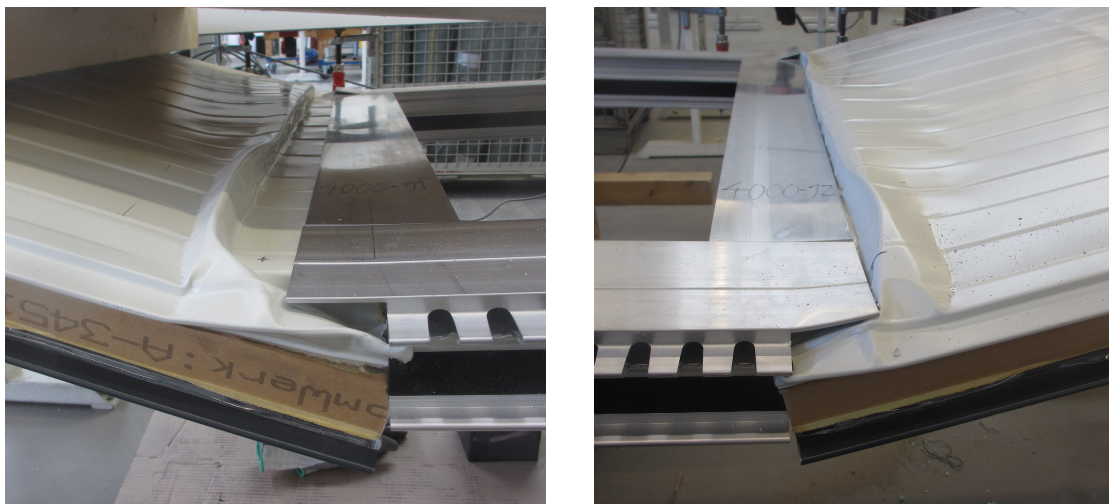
Versagensbild bei den Probekörpern 4000-11 mit Einschubling Typ 2 (links) und 4000-12 mit Einschubling Typ 3 (rechts)
